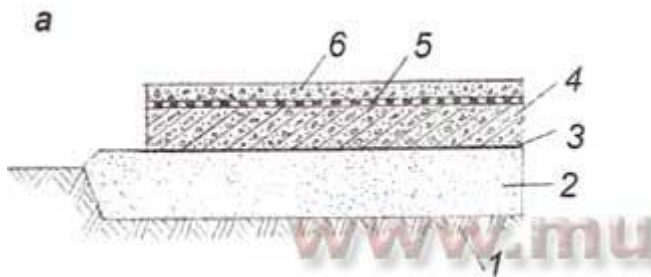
Схеми влаштування незаглиблених монолітних фундаментних плит:
